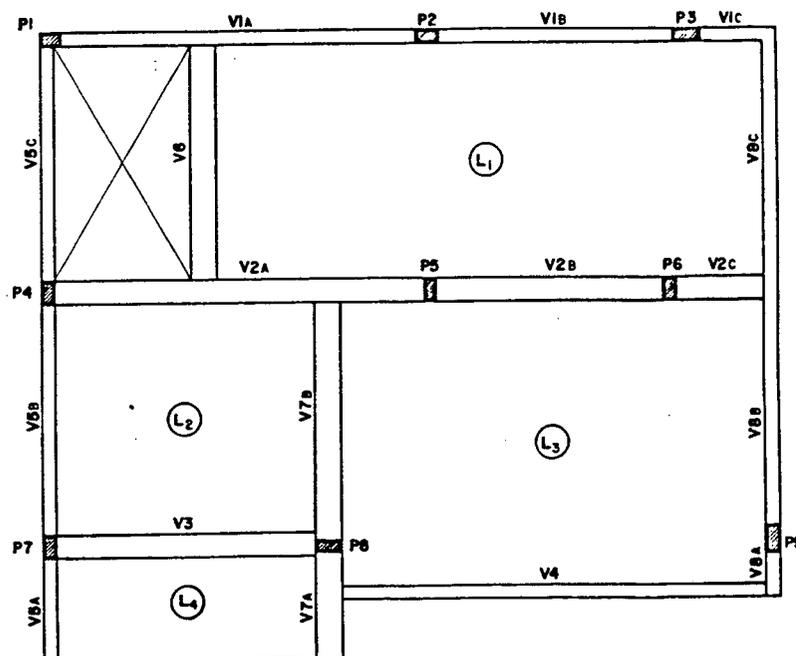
Esquema estrutural para lajes nervuradas - Projeto Médio
